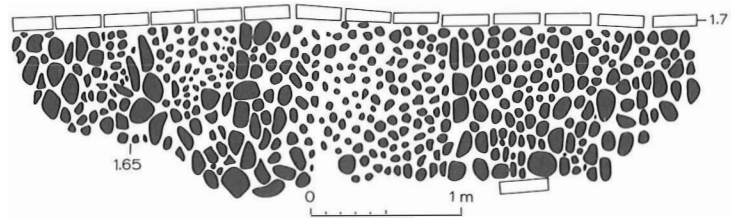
St. Bernardusabtei Aduard. Weg aus Findlingen und Backstein an der nördlichen Querhausfassade. Grundriss.
